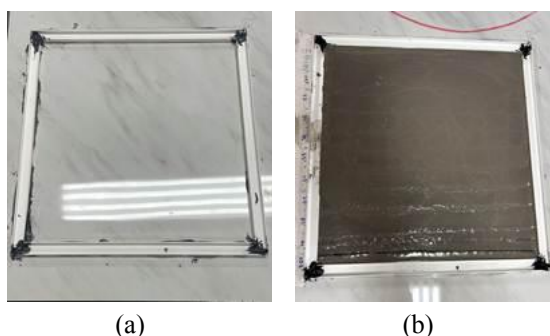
Execução do ensaio de tempo de regeneração (a) área demarcada para o ensaio (b) ensaio de tempo de regeneração
